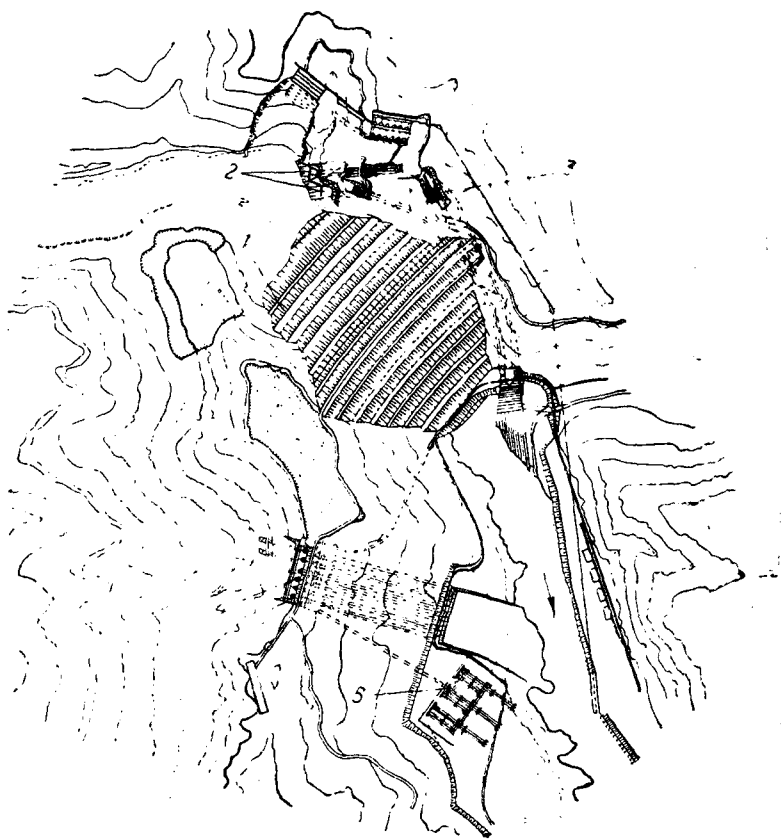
План Саянской ГЭС: 1—каменно-набросная плотина; 2—строительный водосброс; 3—эксплуатационный водосброс; 4—здание ГЭС; 6—открытая подстанция
